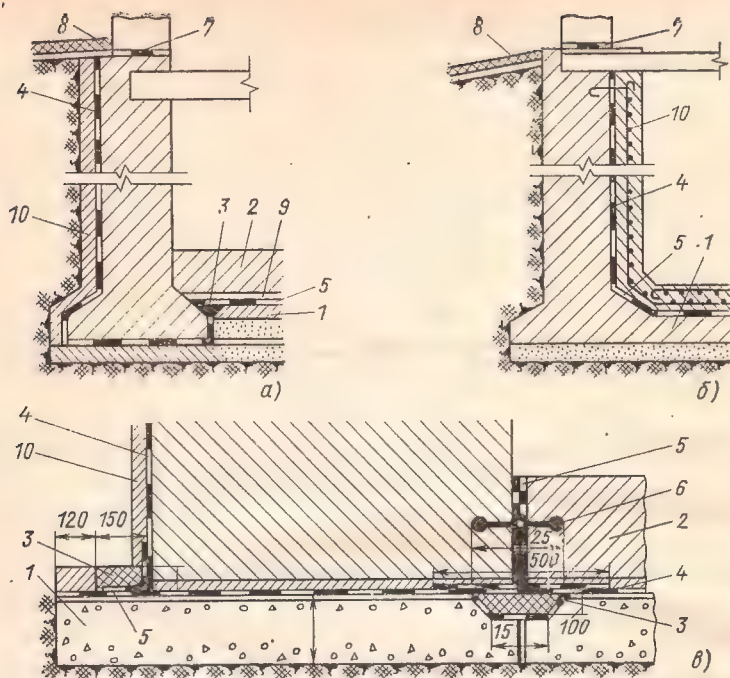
Основные решения гидроизоляции подвальной части здания: а — наружная гидроизоляция, б — внутренняя гидроизоляция; в — узел примыкания стены и пола подвальной части здания; 1 — бетонная подготовка; 2 — гидроизолируемые конструкции; 3 — герметизирующая шпонка; 4 — обмазочная; 5 — гидроизоляция основания или пола сооружения; 6 — дополнительное уплотнение деформационного шва; 7 — противокапиллярная прокладка в стене; 8 — асфальтобетонная отмостка; 9 — защитная стяжка из цементного раствора; 10 — защитная кирпичная стенка или штукатурка
